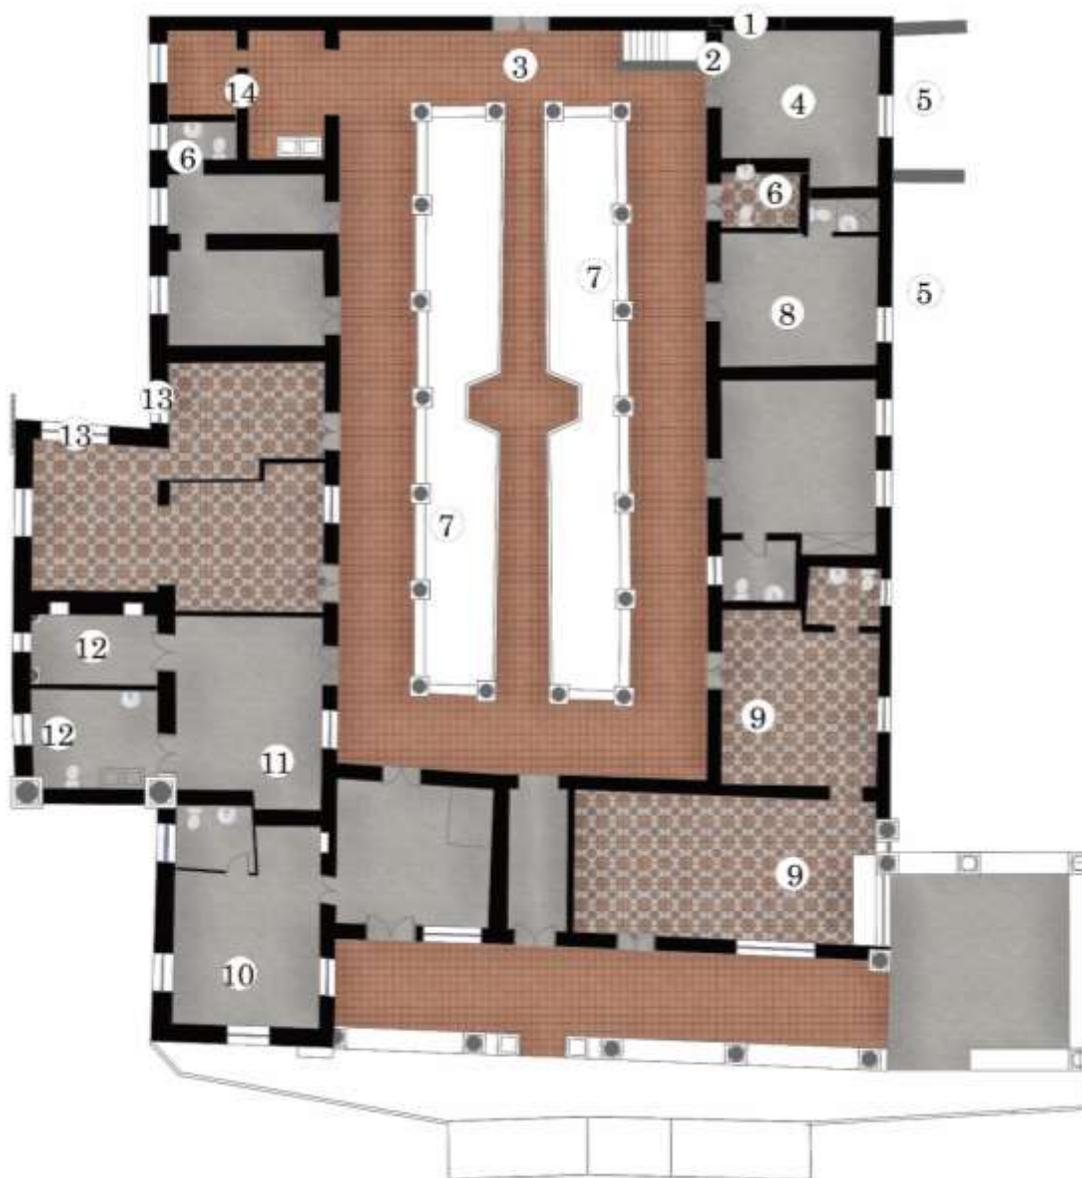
Planta arquitectónica con ubicación de lesiones. Fuente: elaboración propia.
